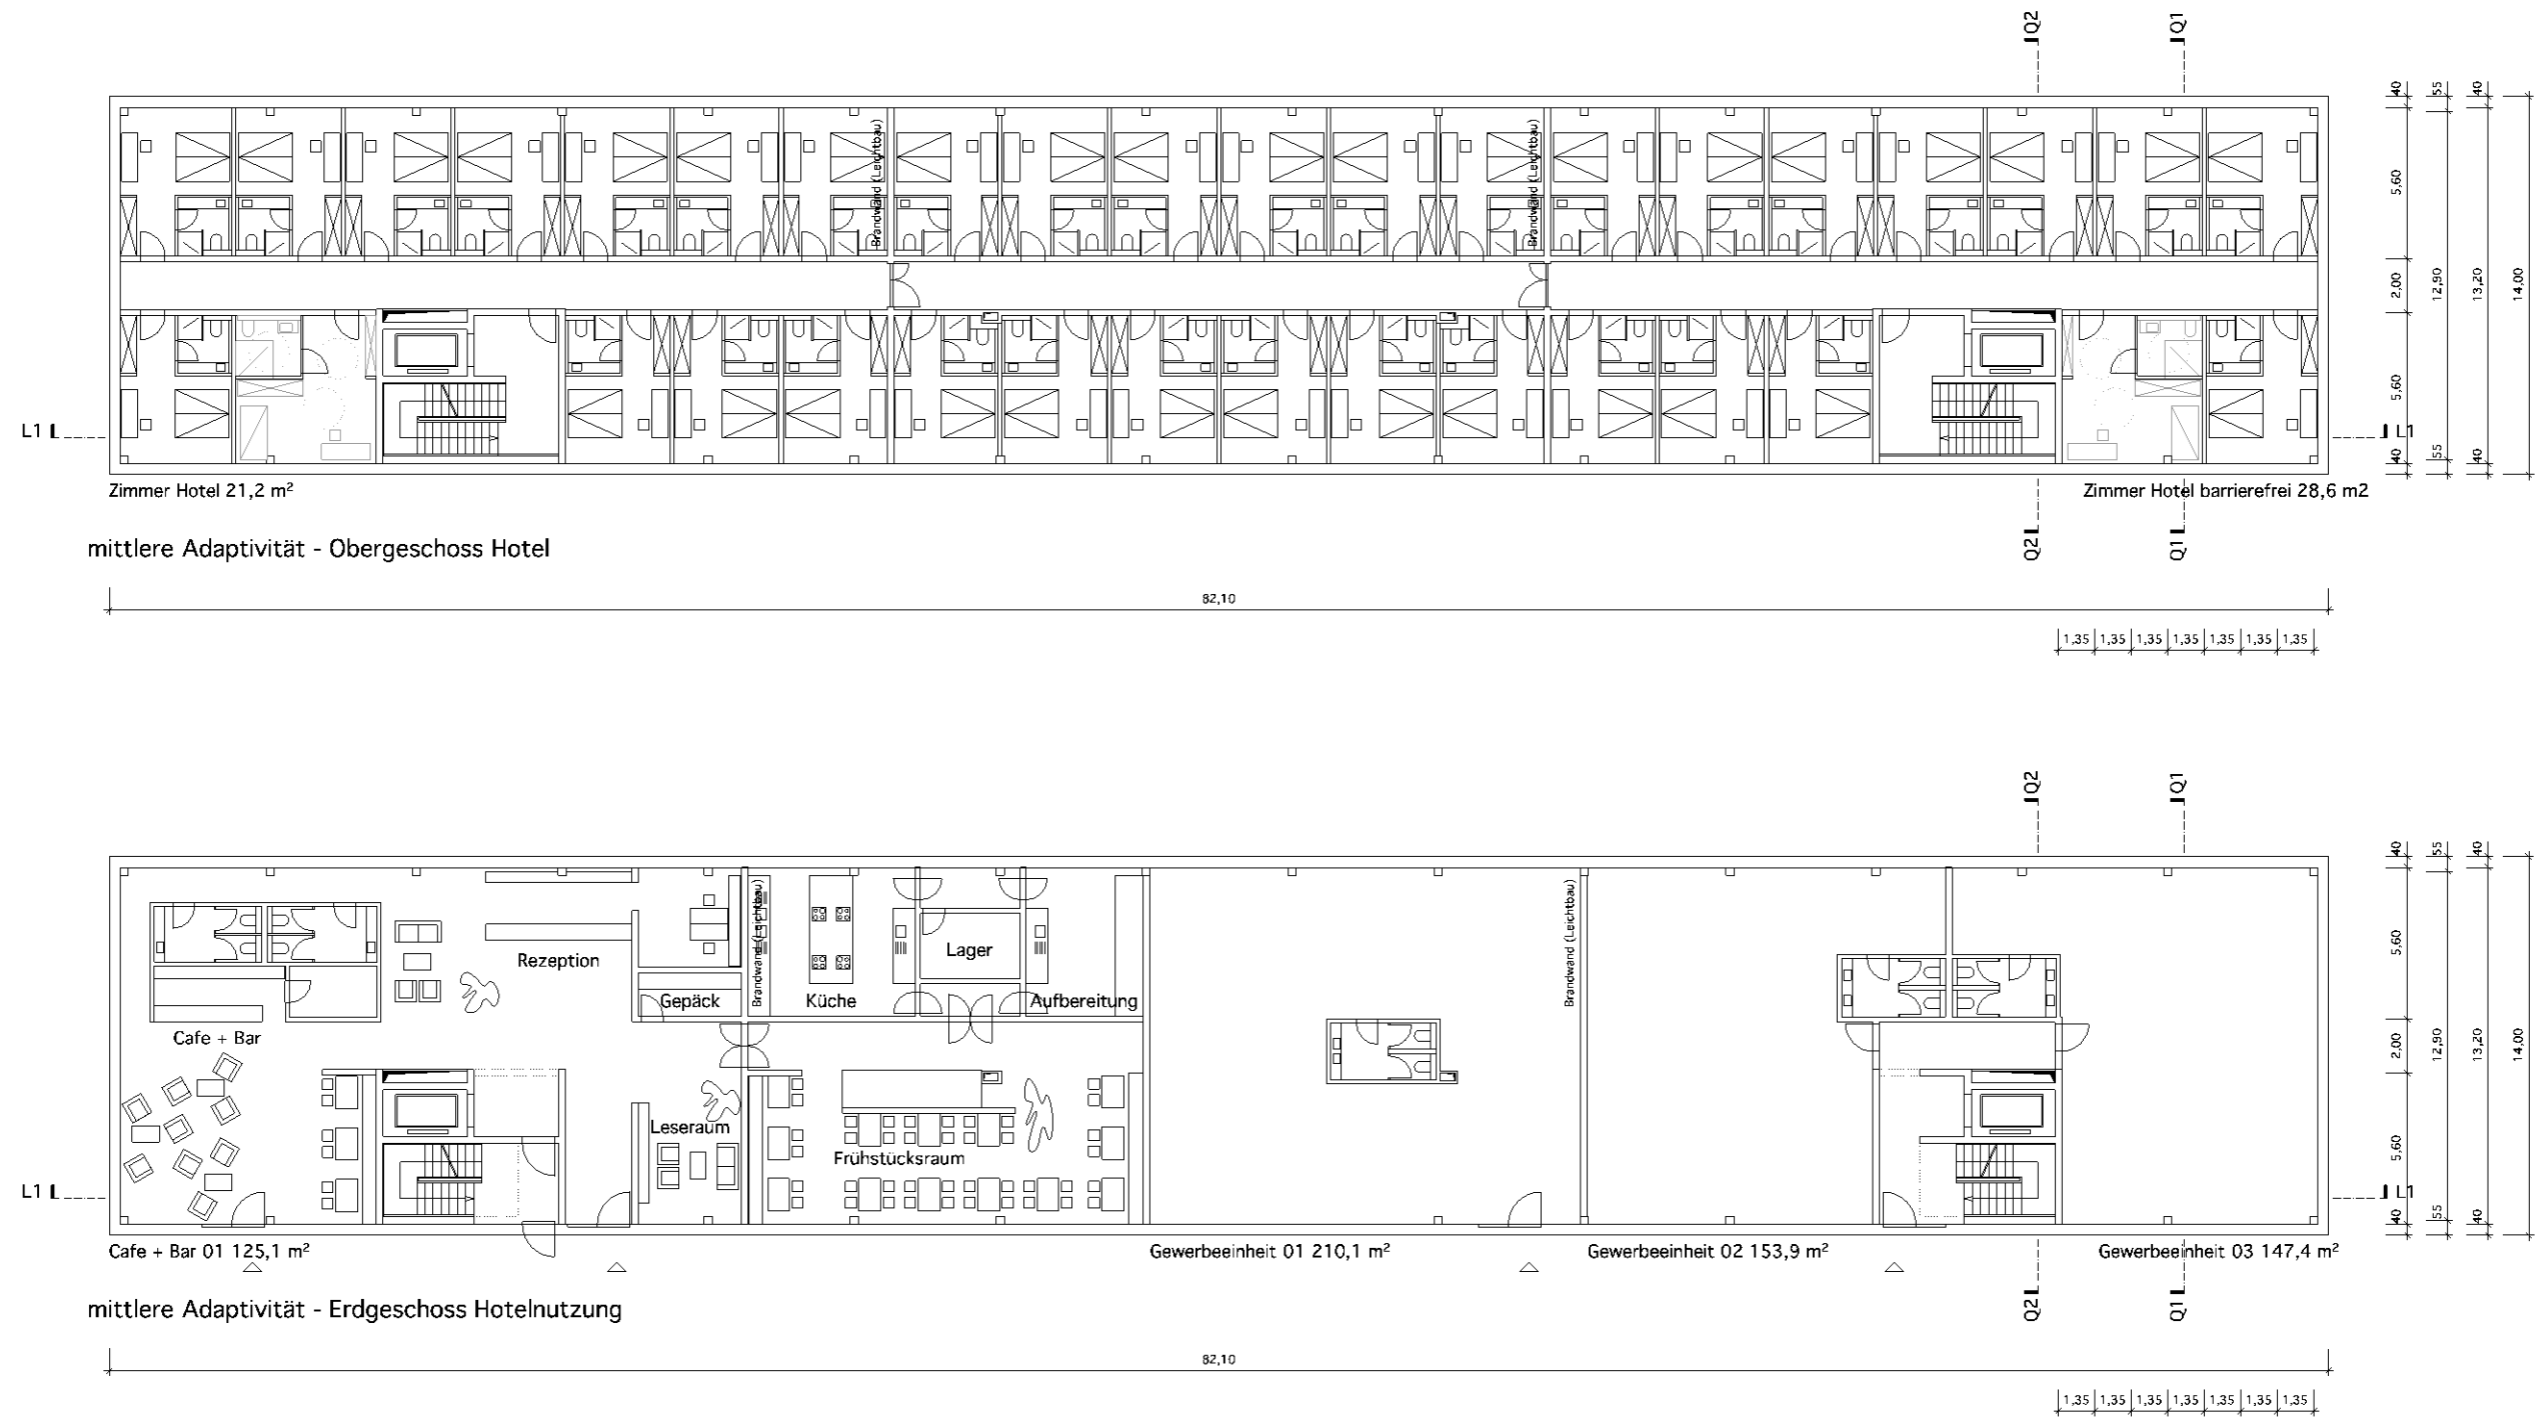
Grundrisse Obergeschoss (oben) und Erdgeschoss (unten) des Referenzgebäudes „mittlere Adaptivität“ für eine Hotelnutzung
